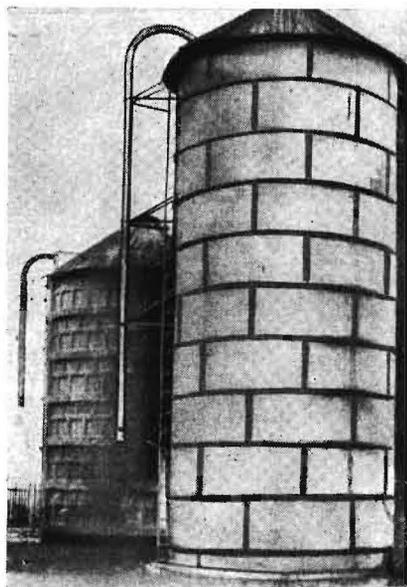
(links). Hochsilo aus Betondauben und aus verzinktem Stahlblech
